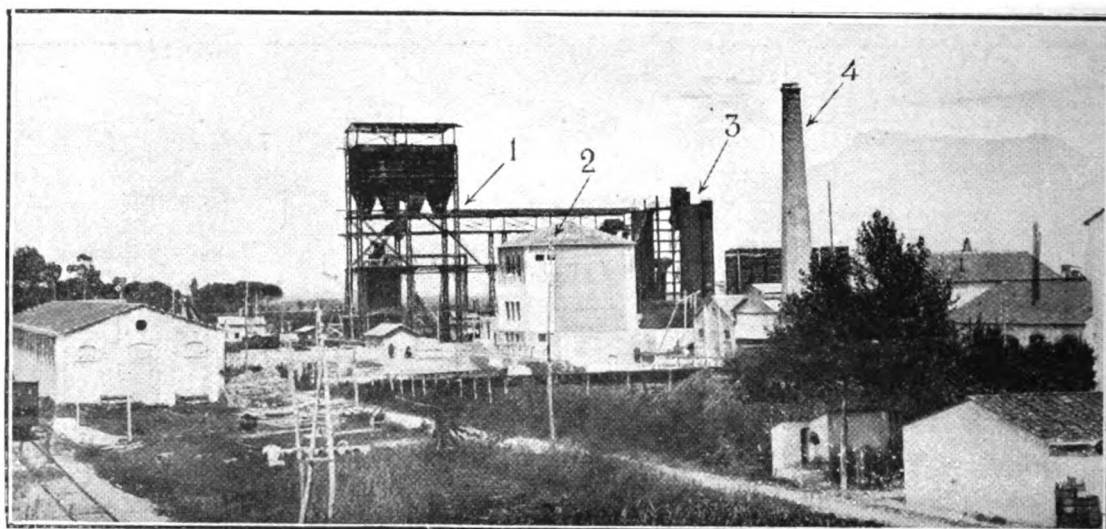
Veduta generale, dalla strada, dell'impianto in costruzione.
